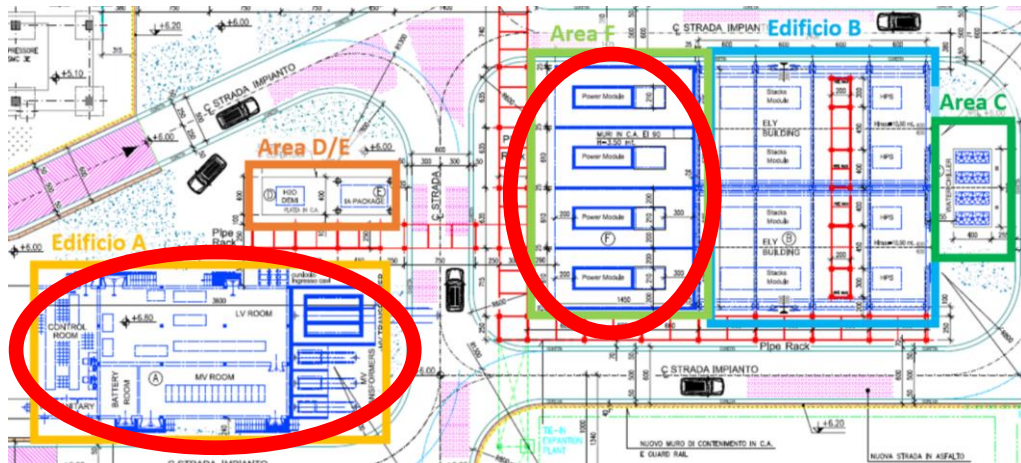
Layout dell'impianto – particolare alimentazione e distribuzione elettrica
